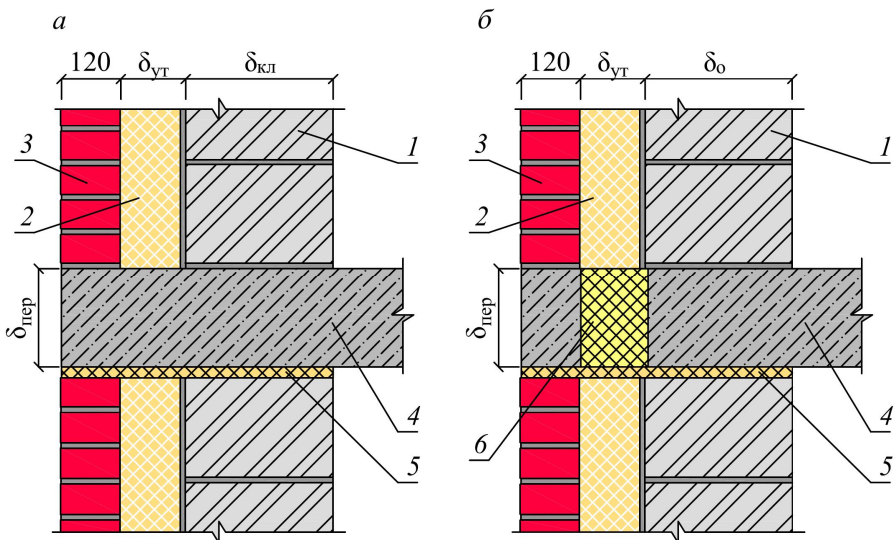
Узел сопряжения ж/б плиты перекрытия (или балконной железобетонной плиты перекрытия) с наружной стеной (*a* – до устройства термического вкладыша в конструкции плиты; *б* – после устройства термического вкладыша в конструкции плиты): 1 – кирпичная кладка (или ограждение иной конструкции); 2 – эффективная тепловая изоляция; 3 – наружная кладка облицовочного кирпича; 4 – железобетонная плита перекрытия; 5 – прокладка; 6 – термический вкладыш (перфорация); $\delta_{ут}$ – толщина слоя тепловой изоляции; $\delta_о$ – толщина ограждающей конструкции; $\delta_{кп}$ – толщина слоя кирпичной кладки
